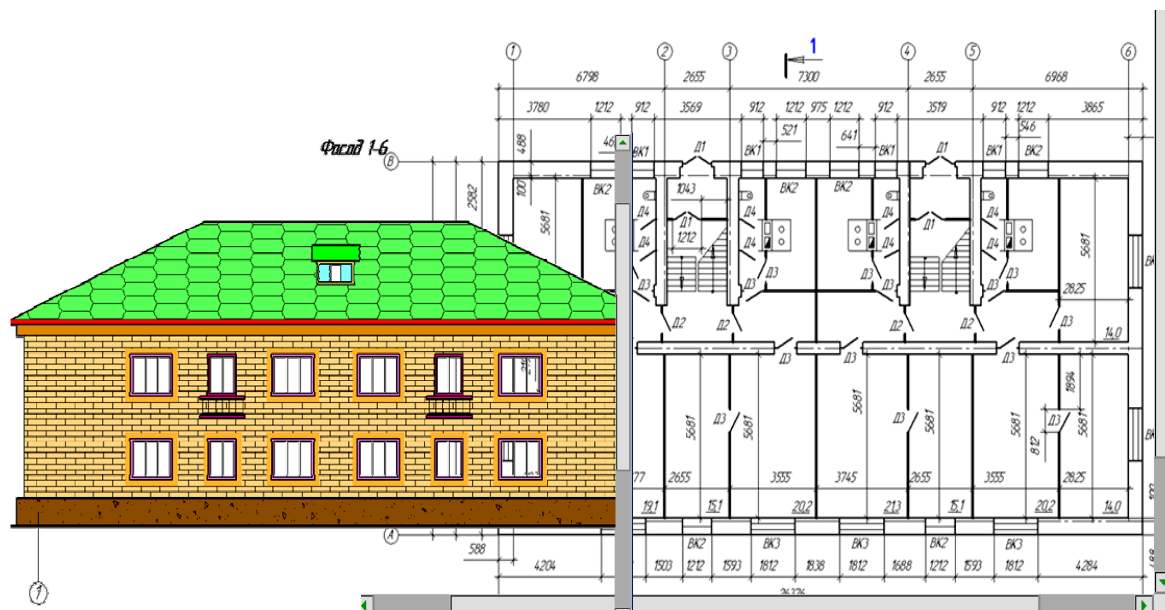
Будівельні кресленики гуртожитку (фасад та план 1-го поверху)
